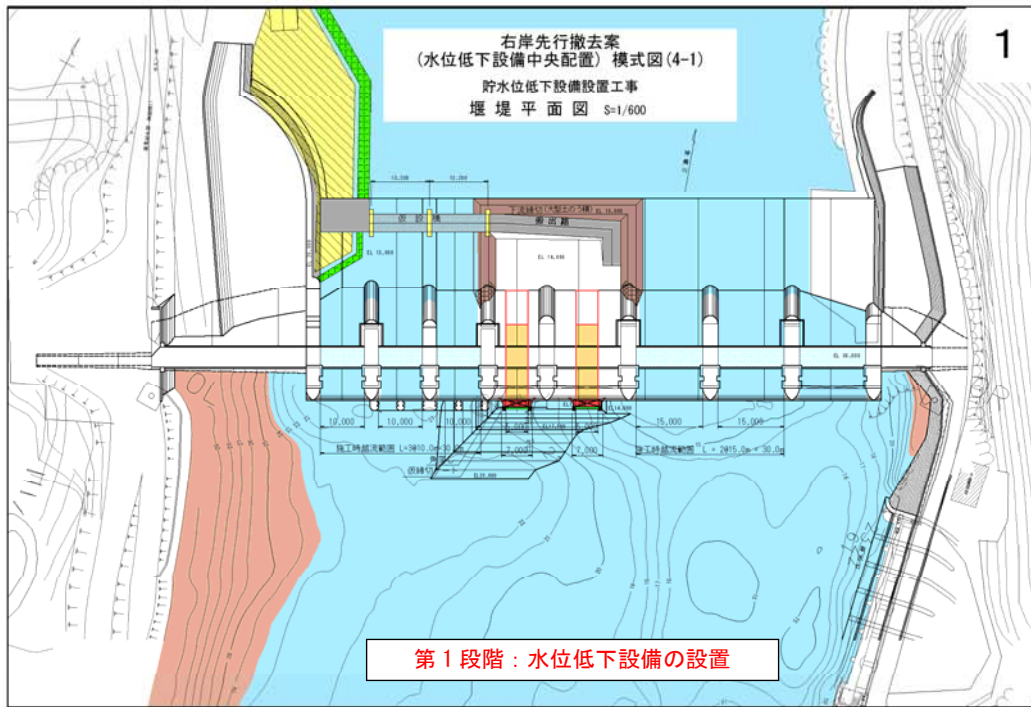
仮設備全体計画図(仮橋のピア配置)
